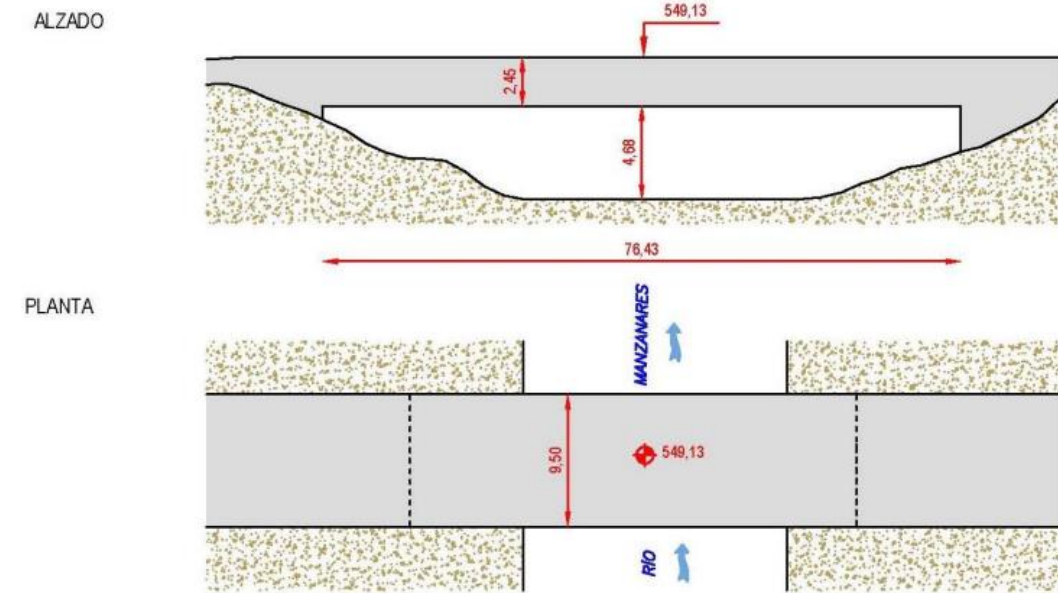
Croquis del puente de acceso a la EDAR Sur (2011)
